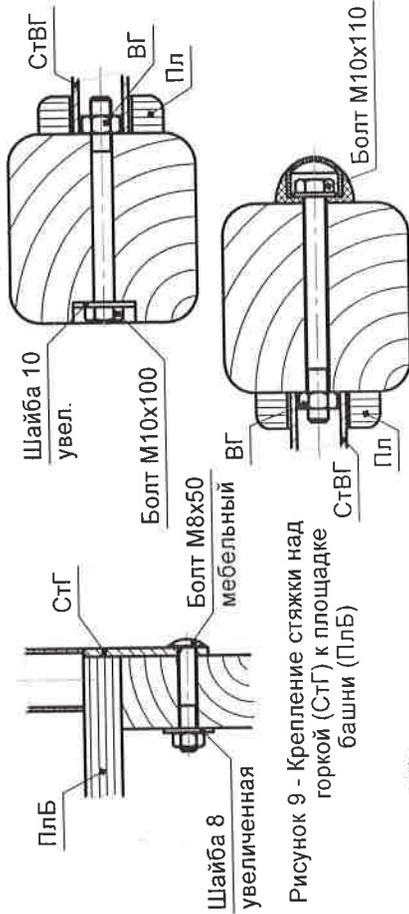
Крепление стяжки над горкой (СтГ) к площадке башни (ПлБ)
